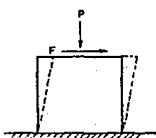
REFUERZO DE ELEMENTOS ESTRUCTURALES (VIGAS Y COLUMNAS).
